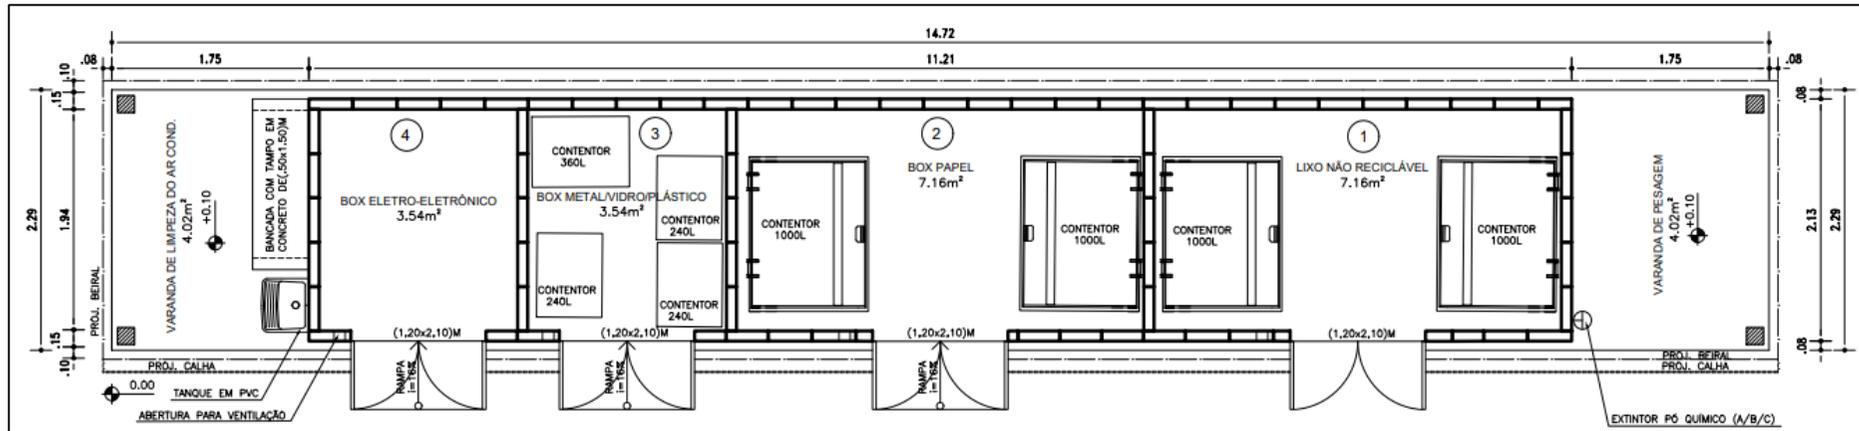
Planta baixa da central de resíduos (nova) do Fórum
